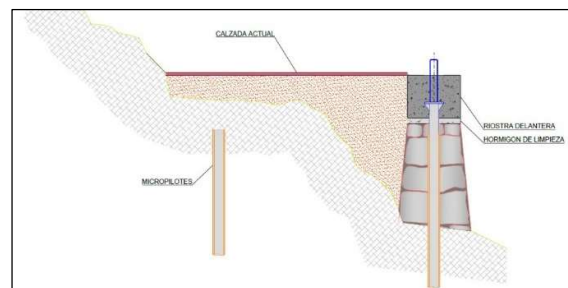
Sección tipo fase constructiva viga riostra delantera.
